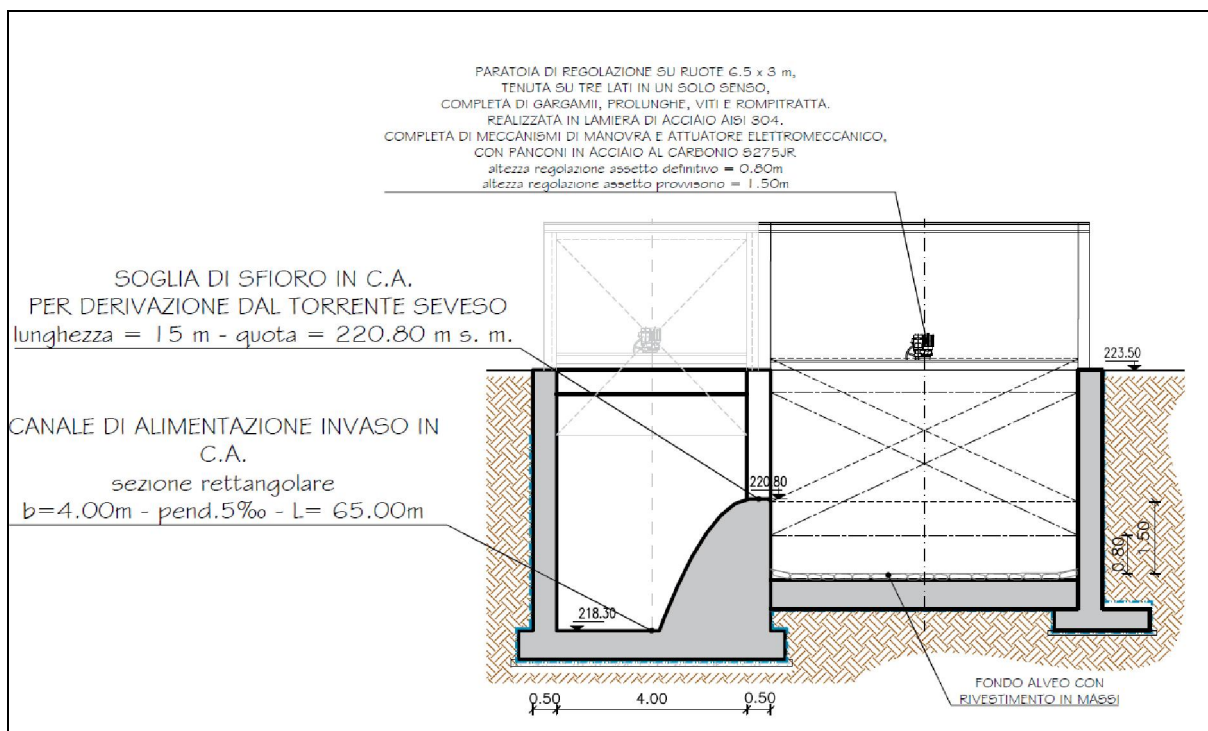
Sezione trasversale di progetto (C-C) dell'opera di presa dal T. Seveso
